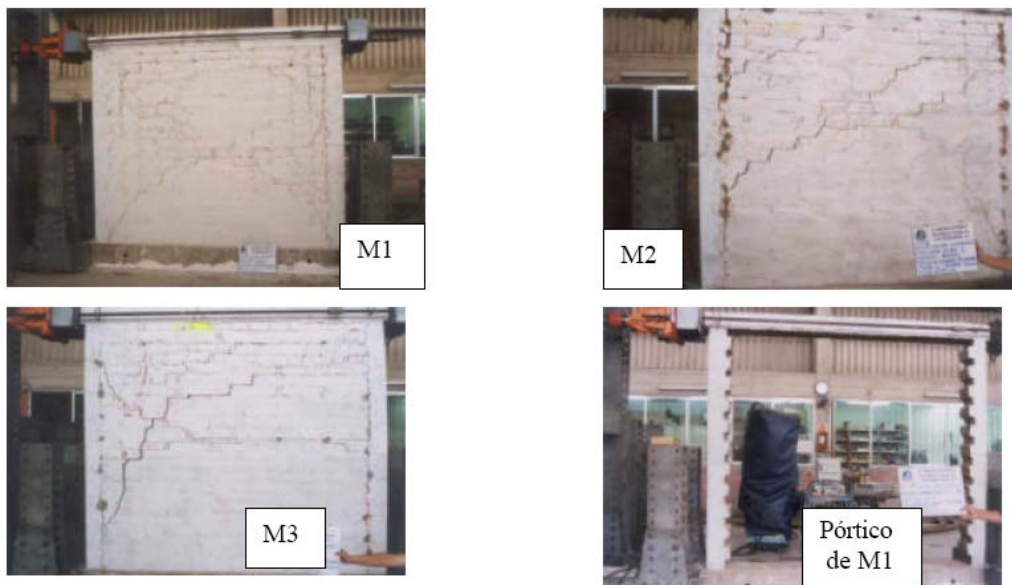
Muros sometidos a carga lateral cíclica, y pórtico de concreto armado.
